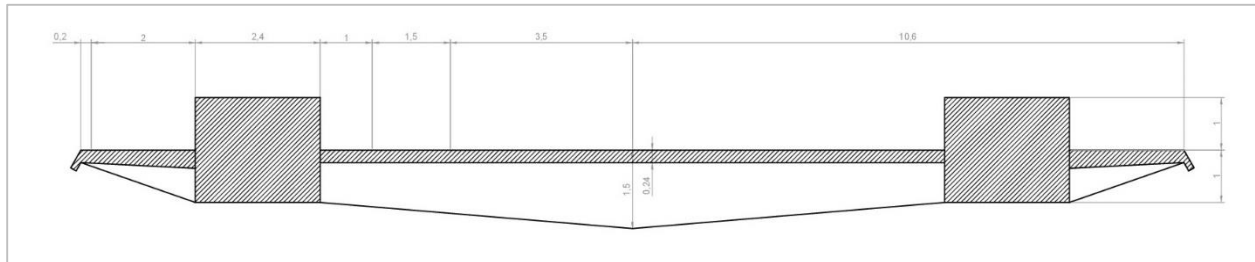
1. Alternativa n°1 – Tablero fijo de hormigón.
